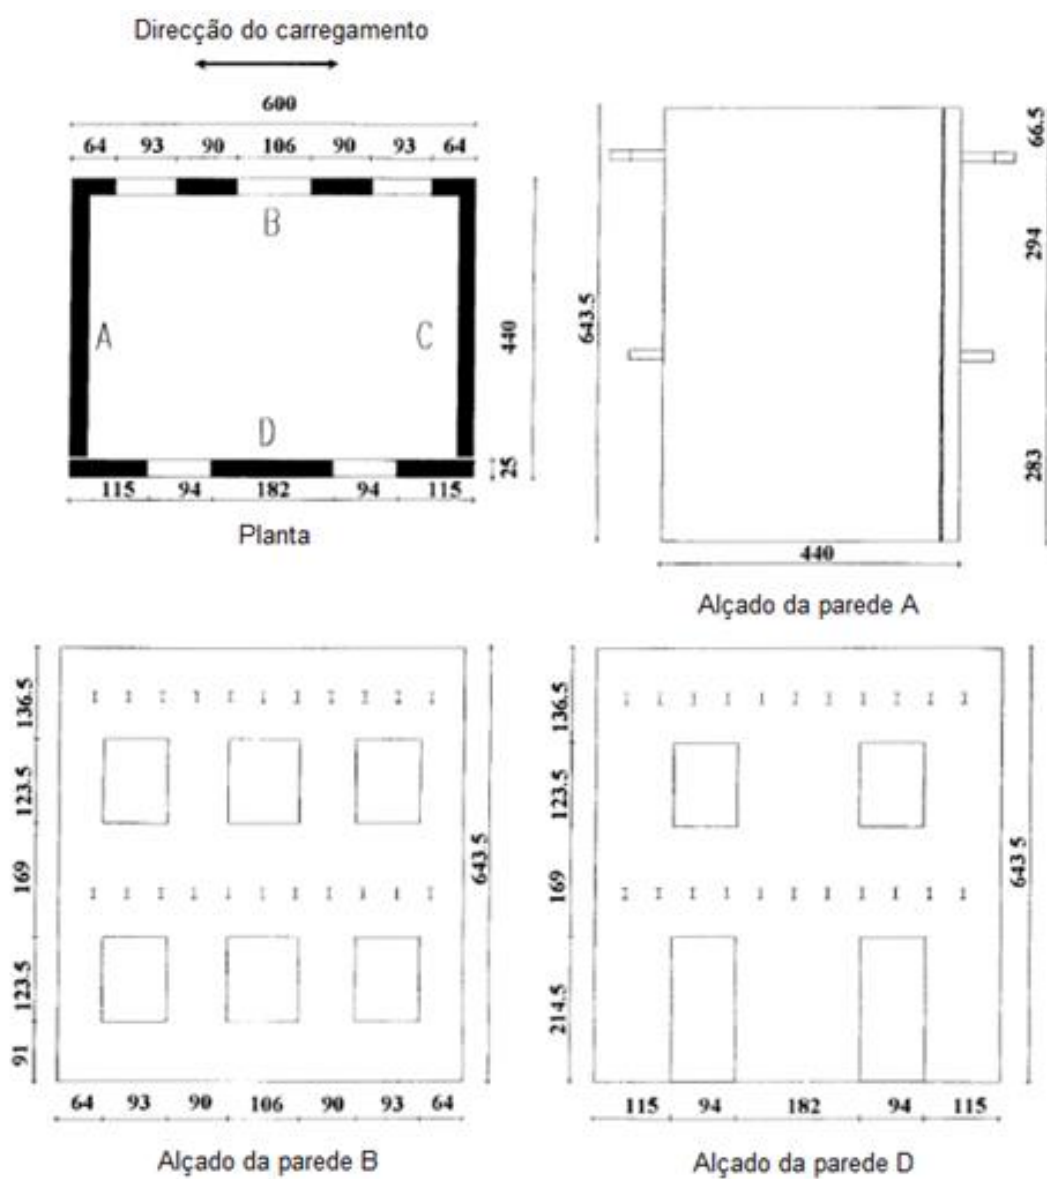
Planta e alçados do protótipo, dimensões em centímetros (Magenes et al., 1995).
